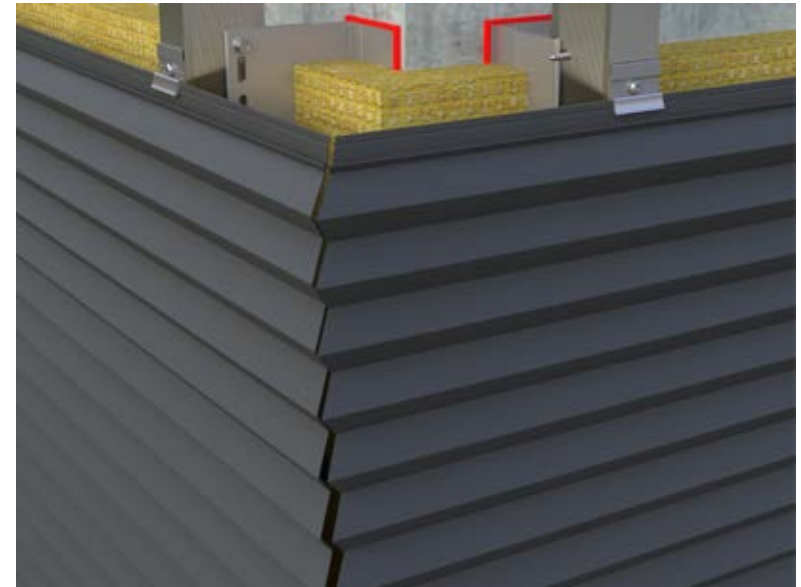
• Profil kantowany do narożnika zewnętrznego
